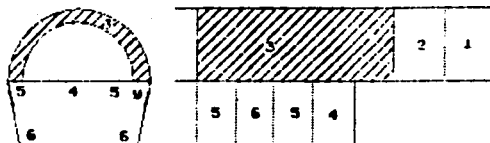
Método belga de excavación por fases, con hormigonado adelantado de la bóveda.
